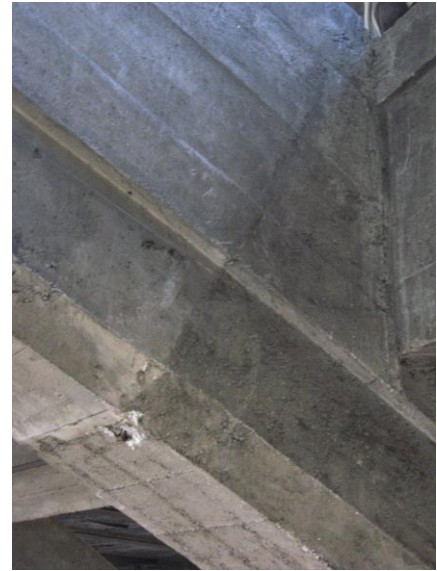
(li.): Knotenpunkt von Kuppelrippe und oberstem Aussteifungsring: Wasserflecken an Stahlbetonrippen und Holzfaser-Dämmplatten der Decke
